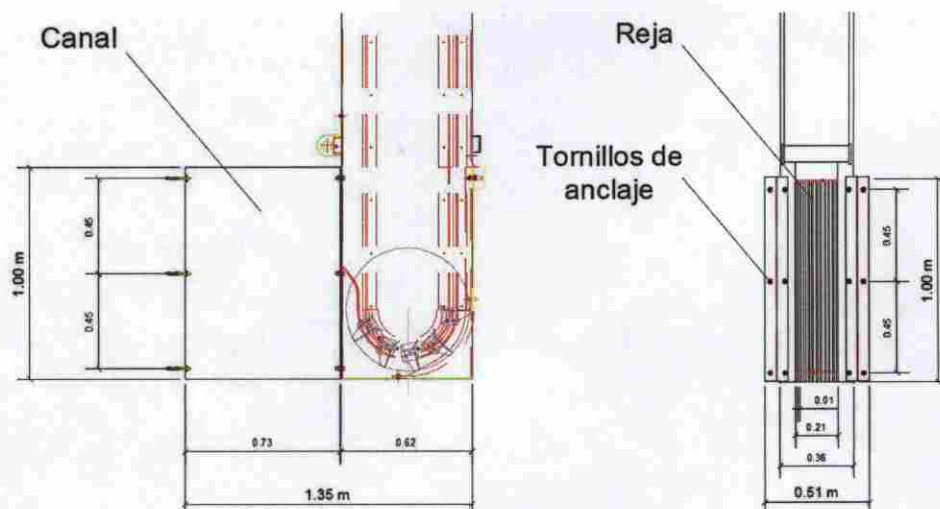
Detalles constructivos del canal y la reja en la entrada de aguas. Fuente: Elaboración propia
